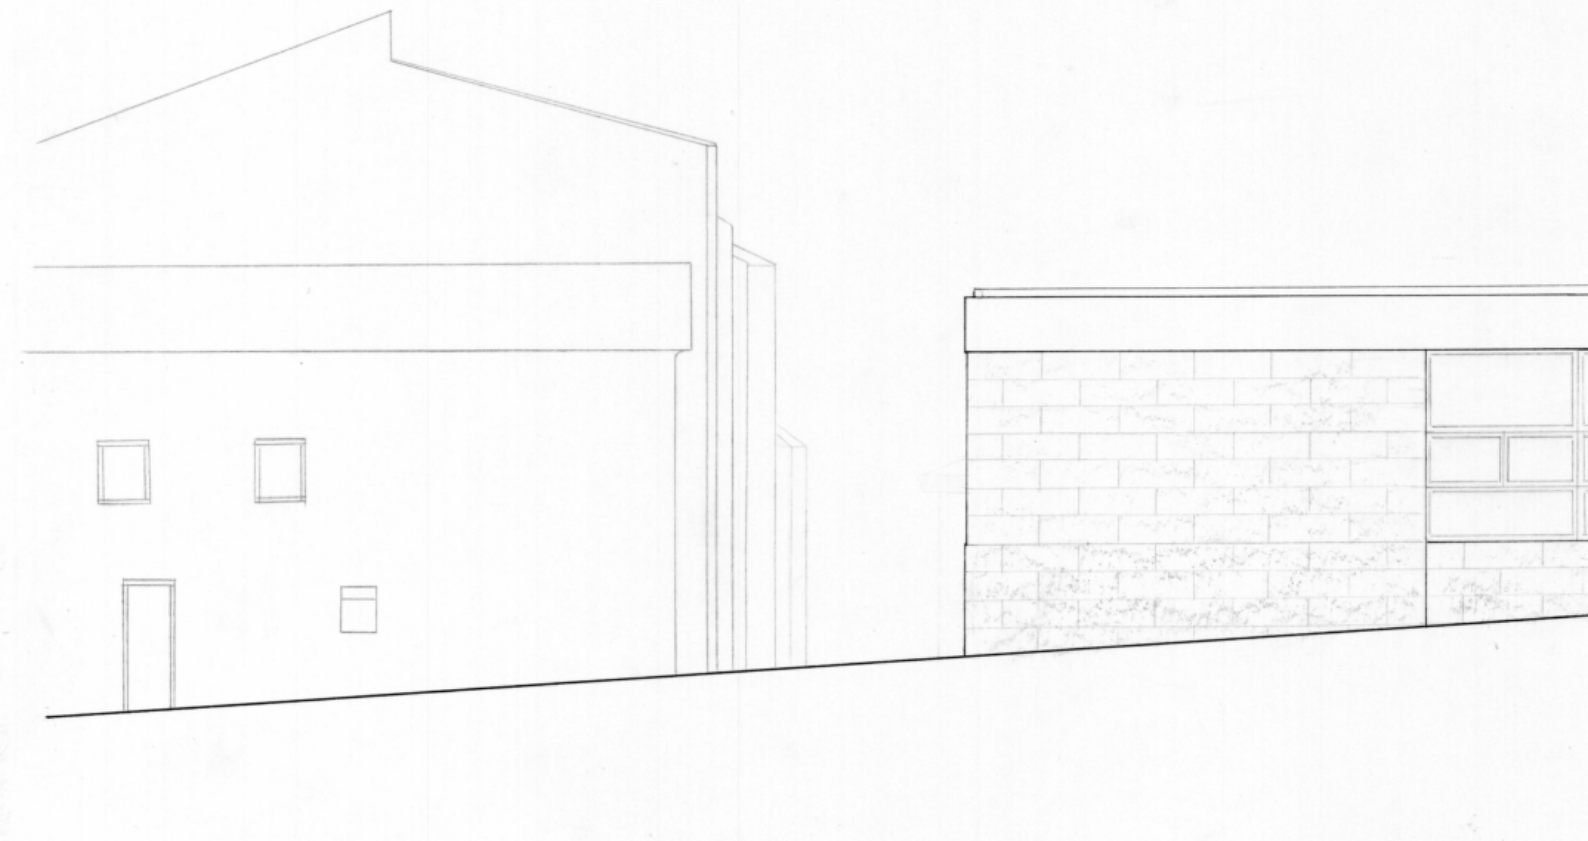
Painel 2 – Alçado nascente, escala 1:100.
